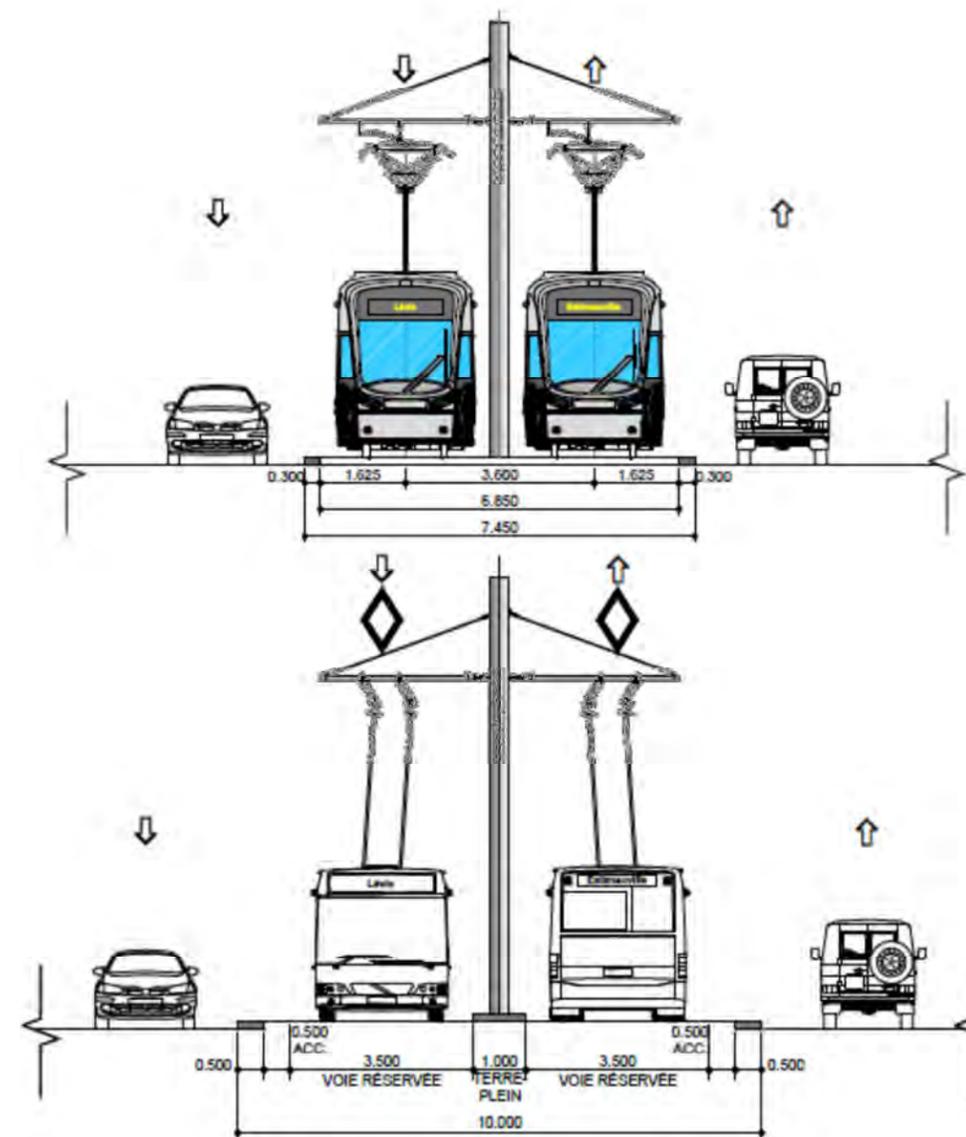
Coupe type 09 de 15 - SRB - Site propre standard - Insertion axiale avec terre-plein central
